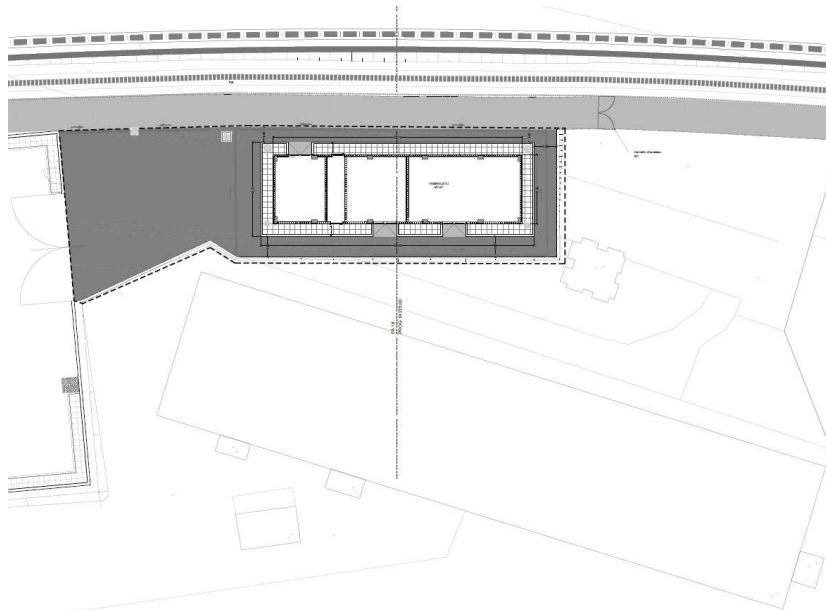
Estratto planimetrico dello stato di progetto – Individuazione dell'area oggetto di intervento con polilinea tratteggiata nera.
